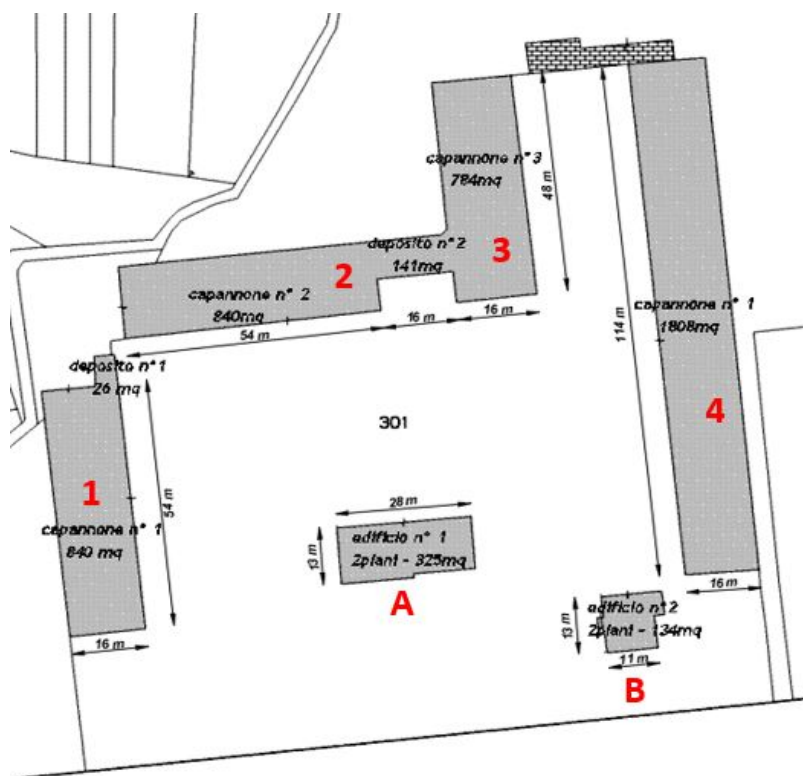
Schema planimetrico del complesso immobiliare "Area capanni Isolabella"
